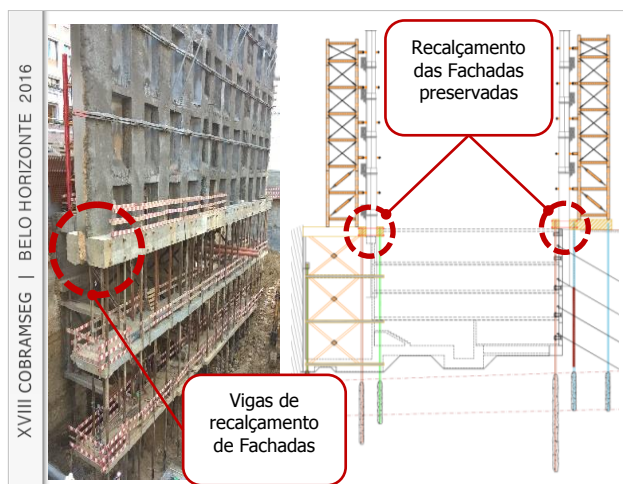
Vistas da solução executada para o recalçamento de fachadas.
